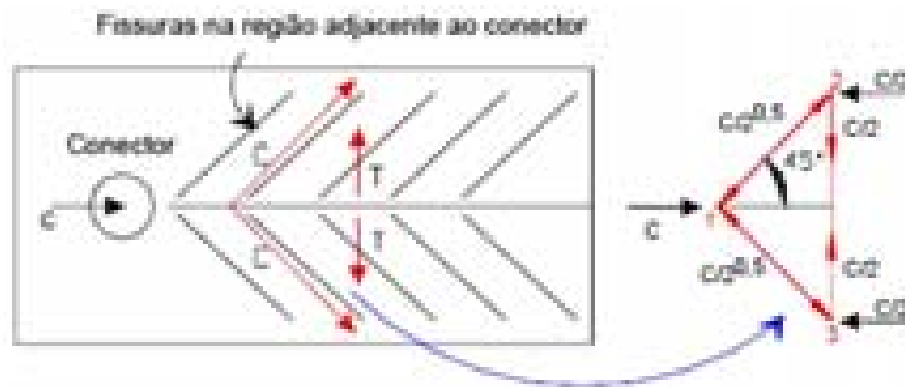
Vista superior da formação de fissuras em uma laje
